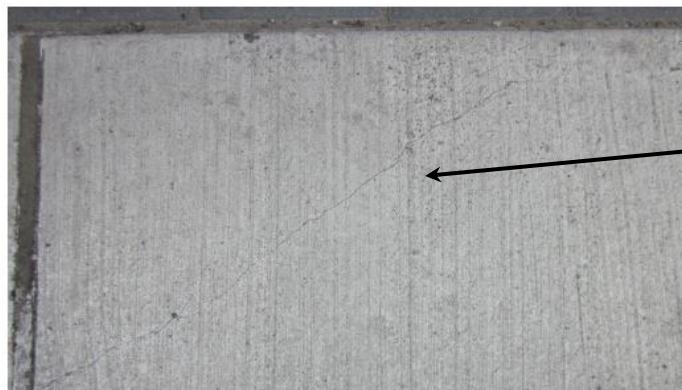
Fissure d'angle précoce dans une dalle de trottoir en béton
